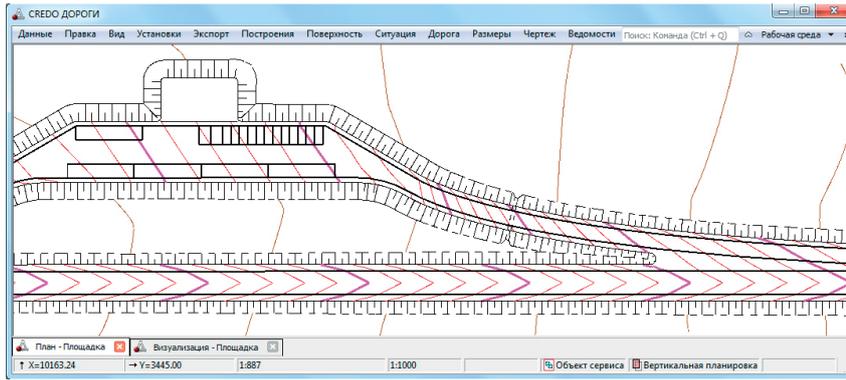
Проект вертикальной планировки площадки для размещения ОДС и подъездов к ней
